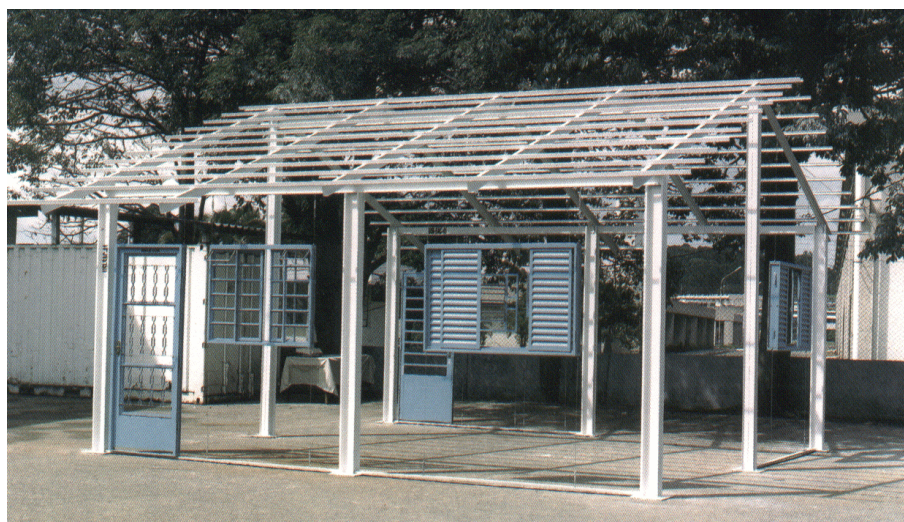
Portas e Janelas da casa do projeto Usiteto
